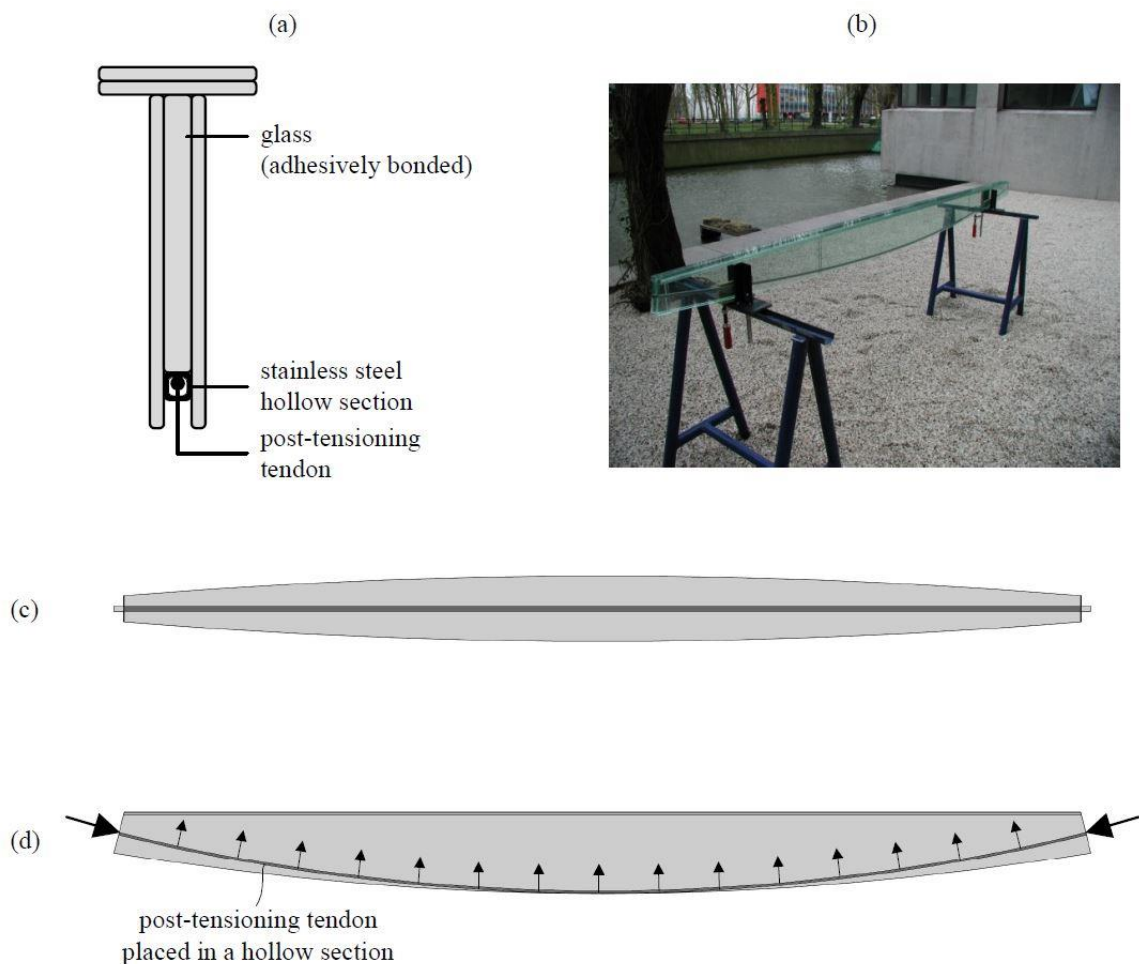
(a) Querschnitt; (b) Foto eines Trägerprototyps; (c) Draufsicht; (d) Seitenansicht [16]
